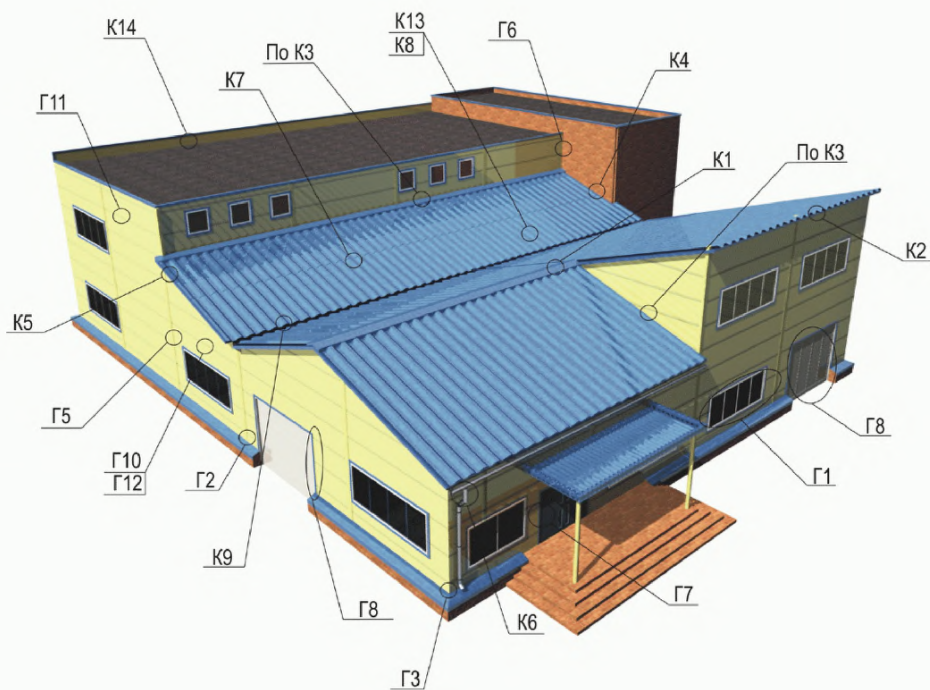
Здание с горизонтальной раскладкой стеновых панелей
